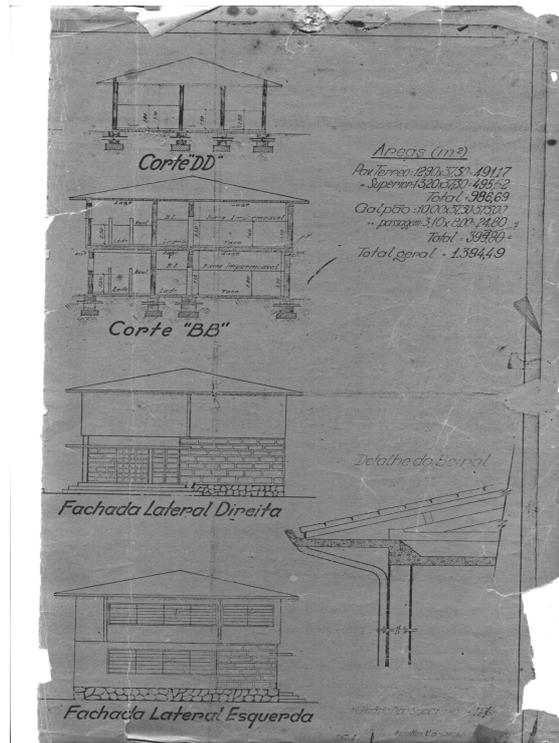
Cópia da planta original do Ginásio Estadual de Pilar do Sul
